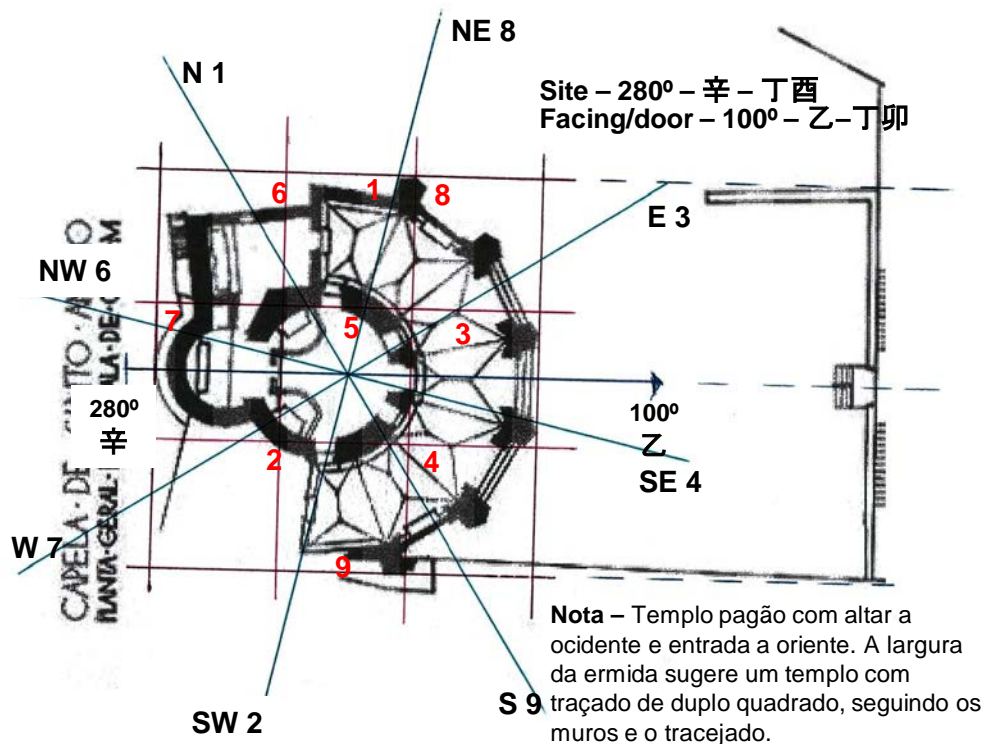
Ermida de Santo Amaro – Direções e orientações – planta, (www.monumentos.pt).
